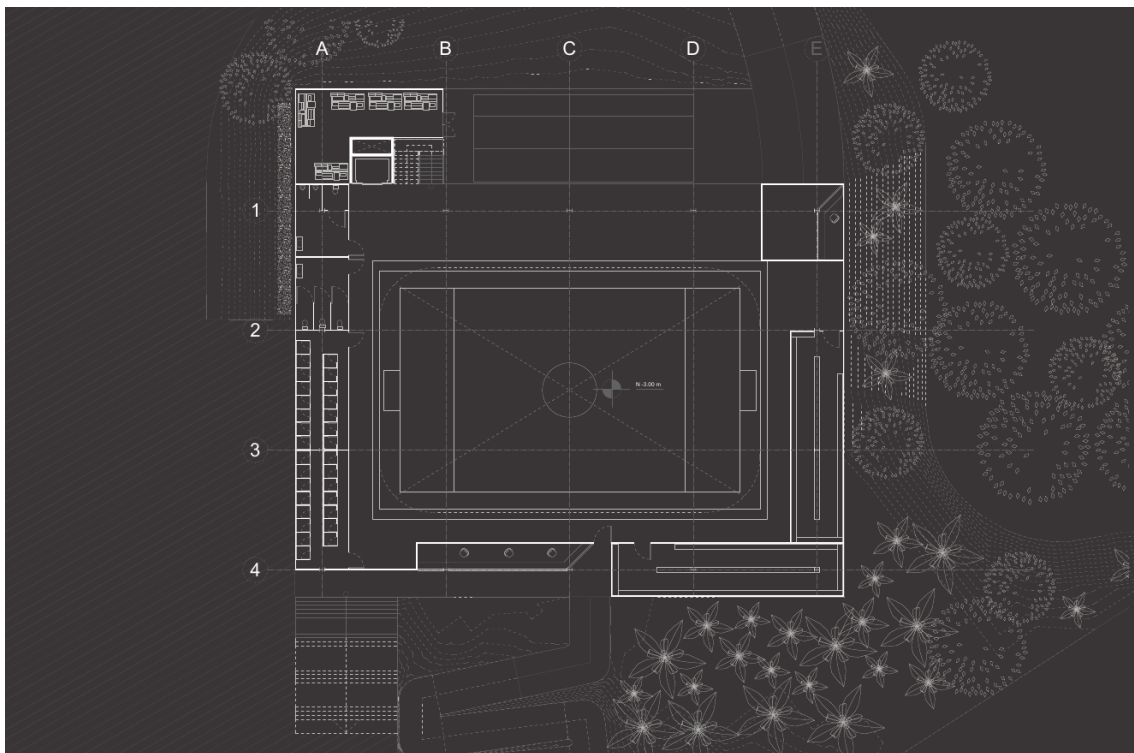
Planta -3.00 Bloque deportivo recreativo, Fuente: Elaboración propia
